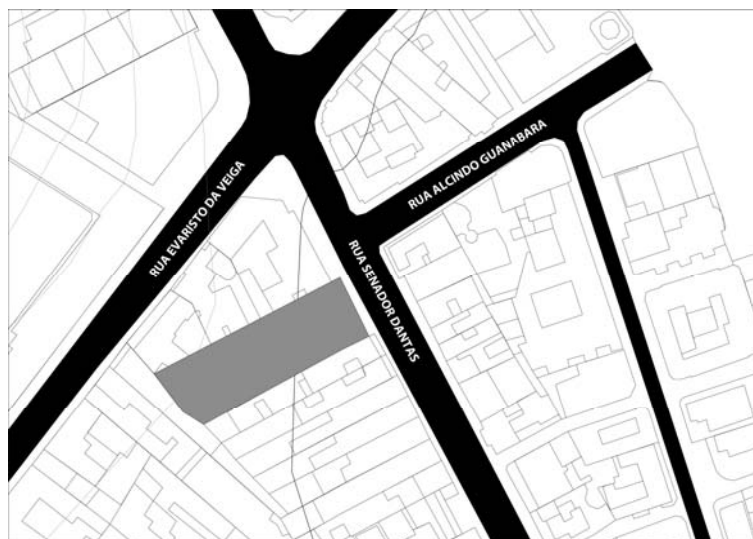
Planta de localização (sem escala) do Cine Vitória, no pavimento térreo do Edifício Rívoli.
